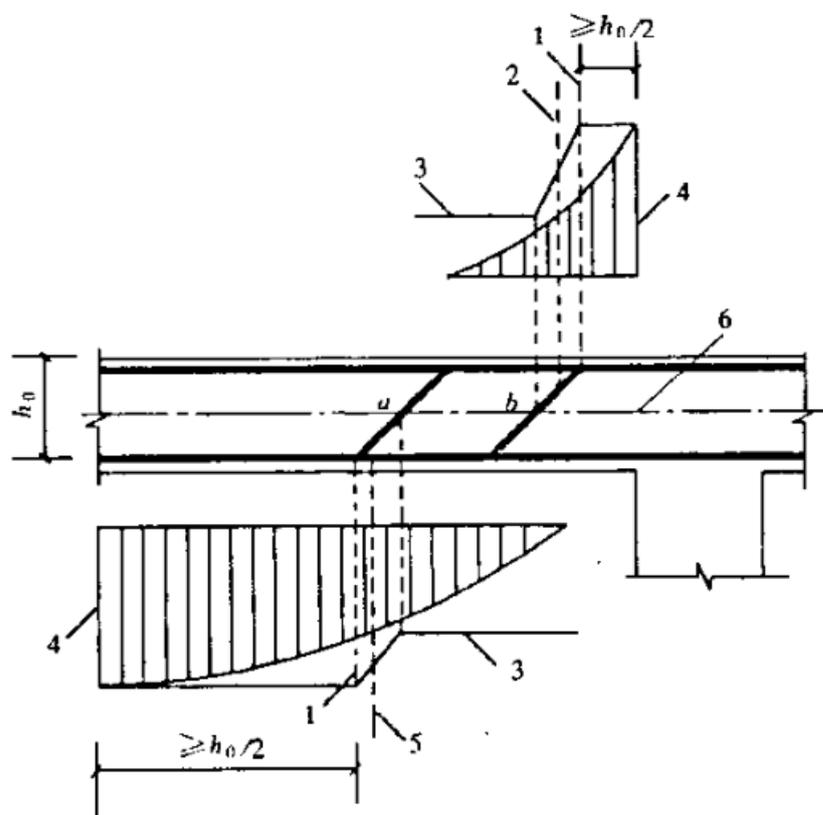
弯起钢筋弯起点与弯矩图的关系
